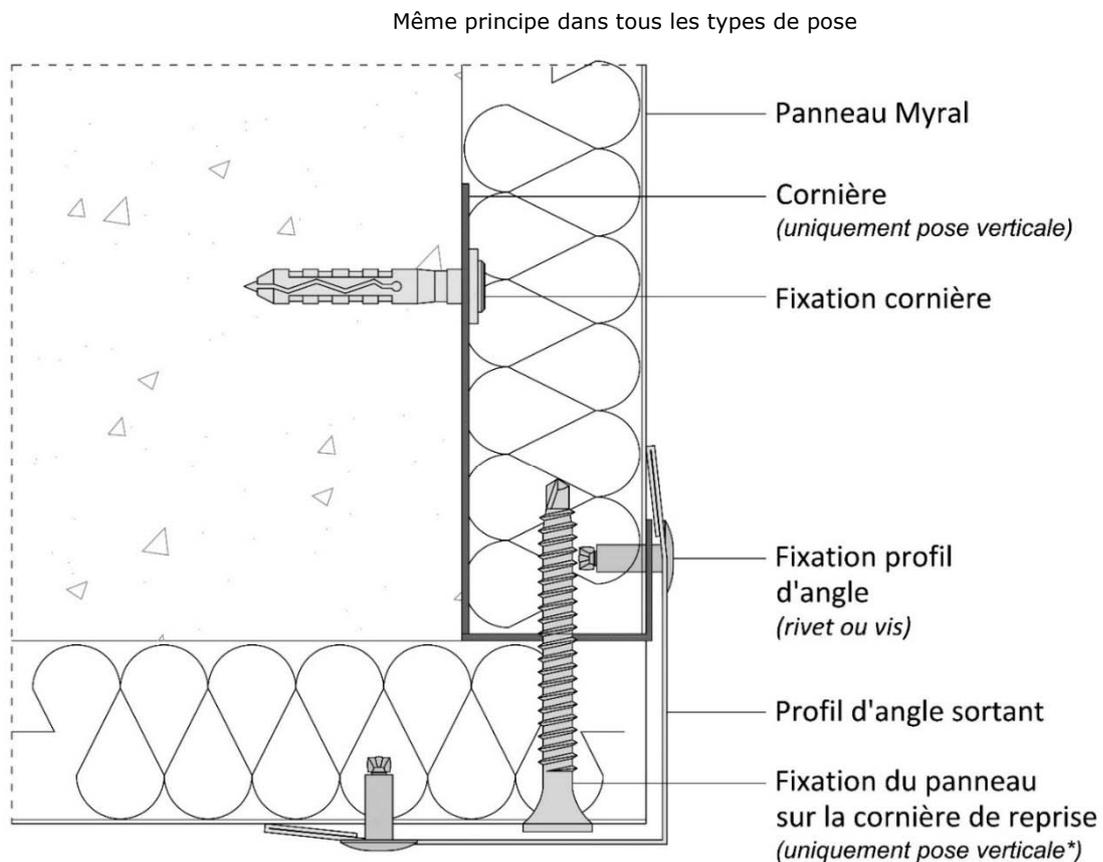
Angle sortant – Pose en vêtage, lame verticale (coupe horizontale)
